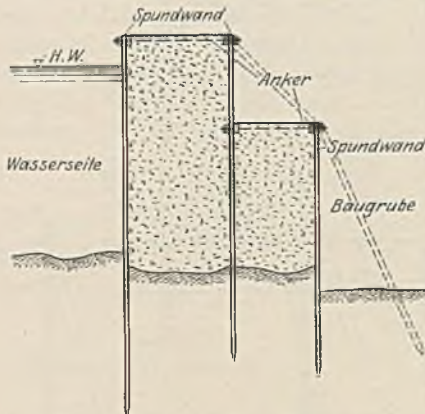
Hoher Kastenfangedamm mit 3 Spundwänden.
